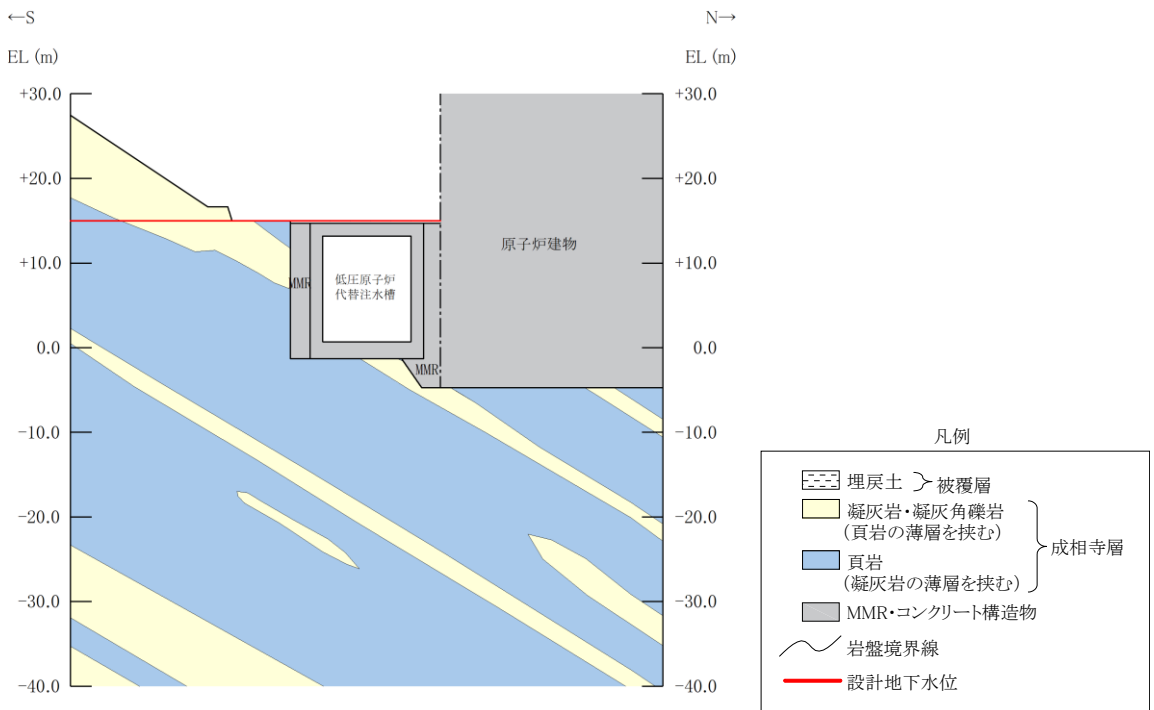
低圧原子炉代替注水ポンプ格納槽 評価対象断面図 (B-B 断面)
